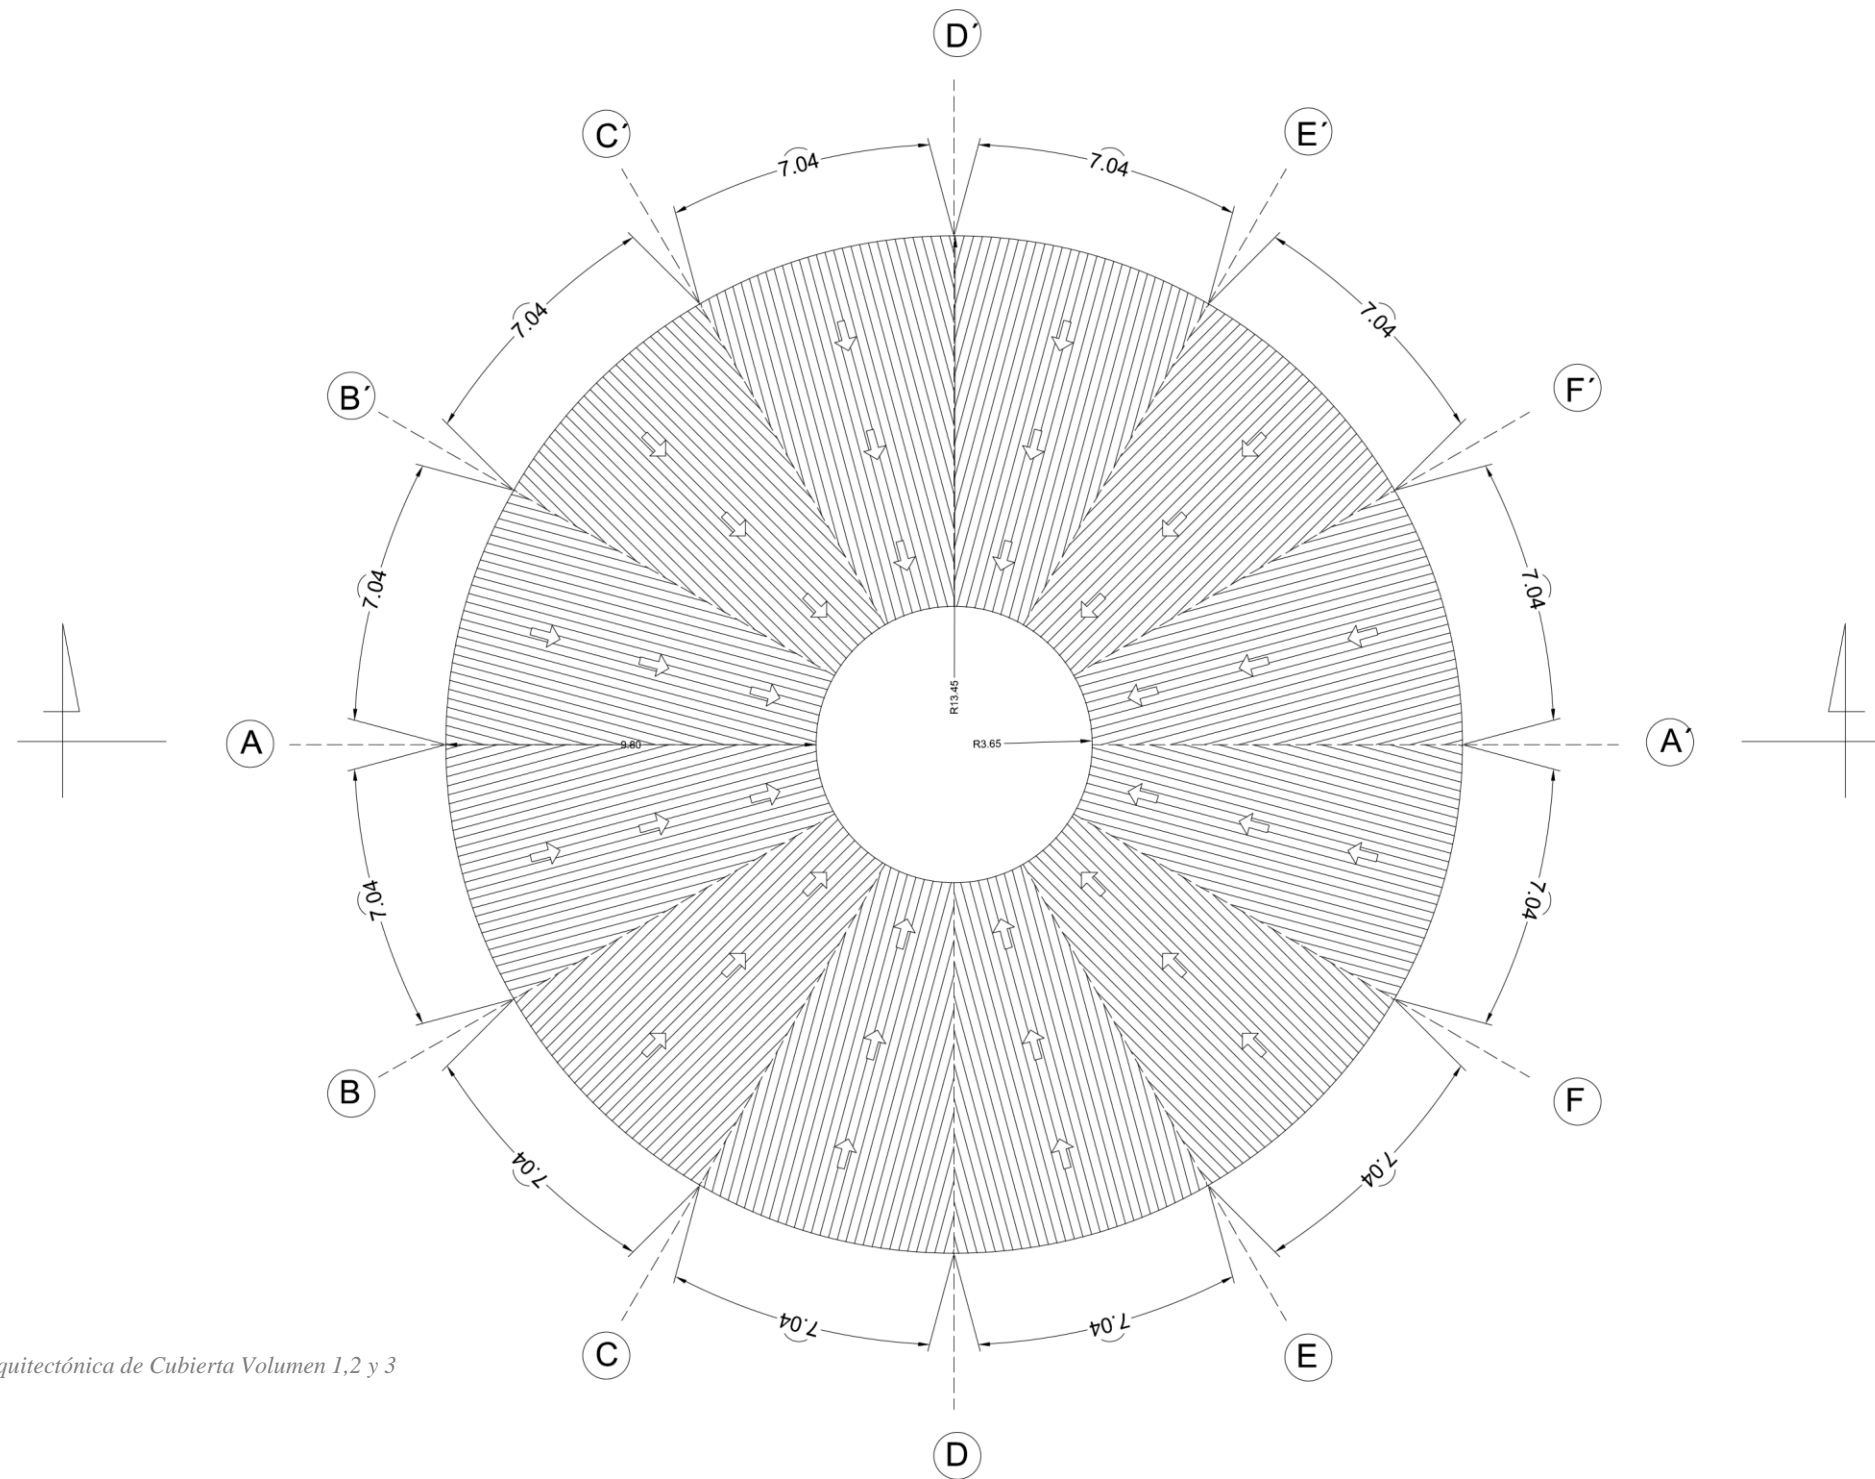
Planta Arquitectónica de Cubierta Volumen 1,2 y 3
